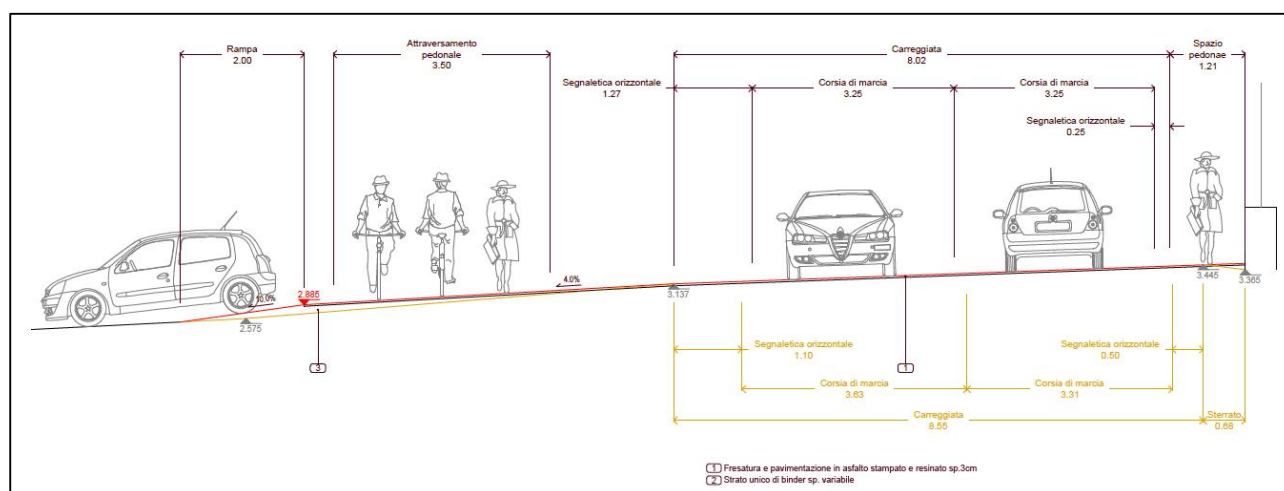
Sezione 24 di progetto trasversale SP delle Collacchie
